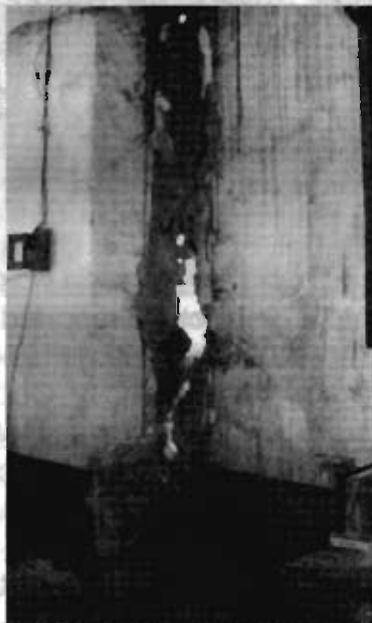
Detalle de la fractura vista en el interior de la Parroquia. Nótese la separación que existe entre los muros
